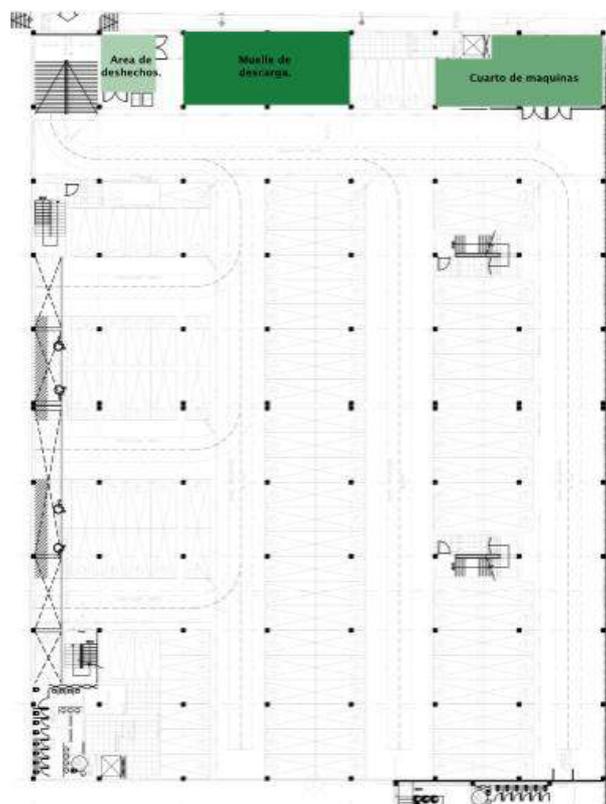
Zonificación CC Juan Cajas. Subsuelo 1 Planta existente.
